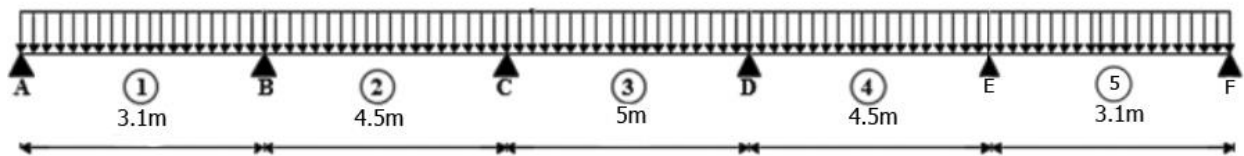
Schéma du 2^{ème} type de poutrelle
